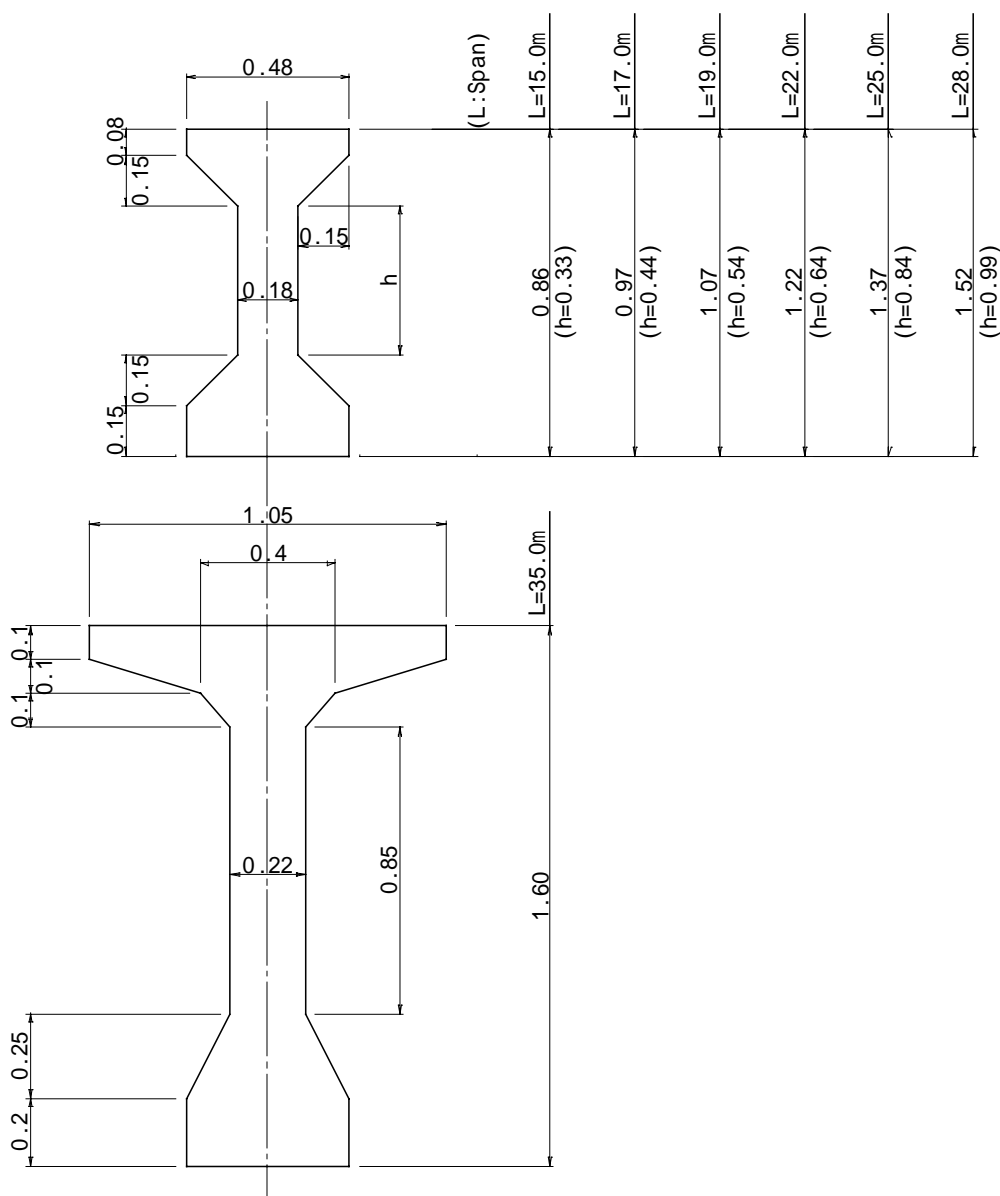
Vigas Estándar PCI de Puentes (Costa Rica)
